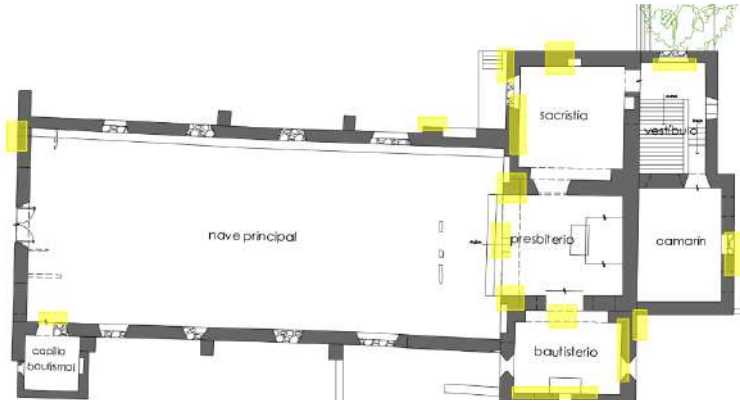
Ubicación de grietas en la edificación. Fuente: Elaboración propia.
